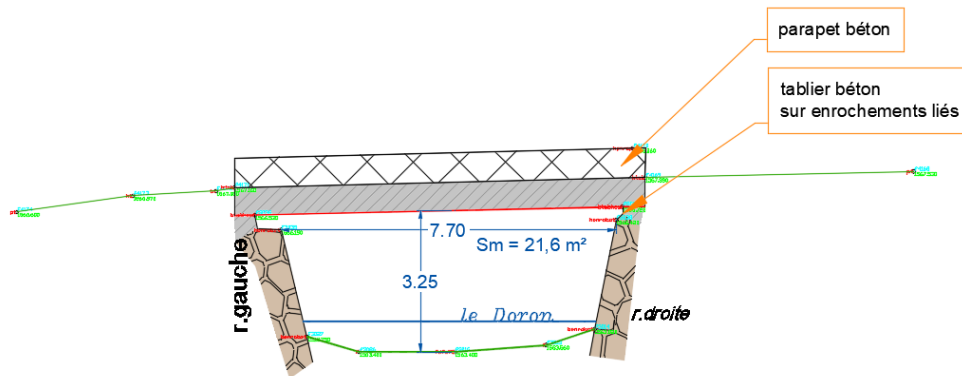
Ouvrage traversant n°1 – profil topographique (face amont)
